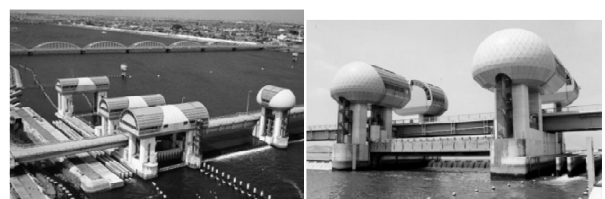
開門ゲート 写真-3 ロック式魚道ゲート
